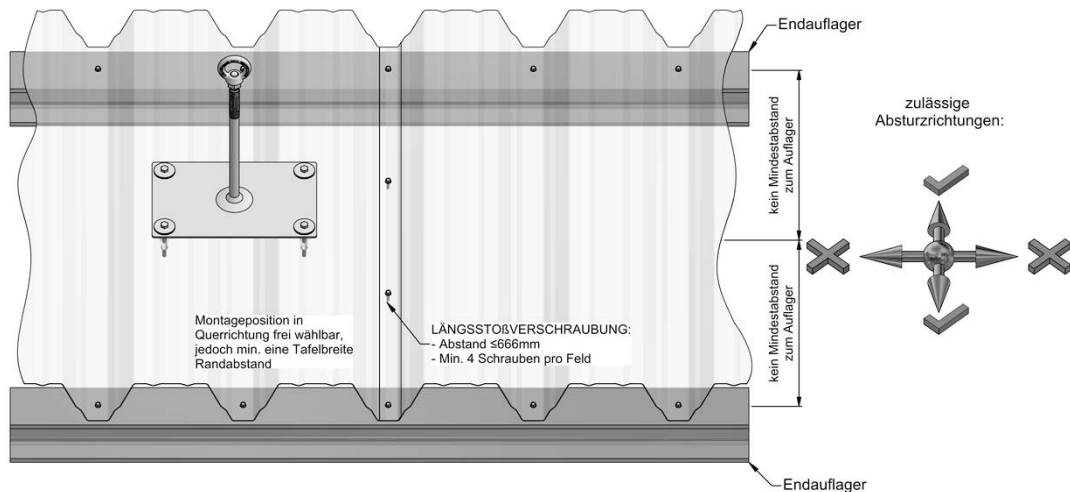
Montagevorgaben auf Trapezprofil (Positivlage) bei Absturzrichtung in Trapezprofilspannrichtung
